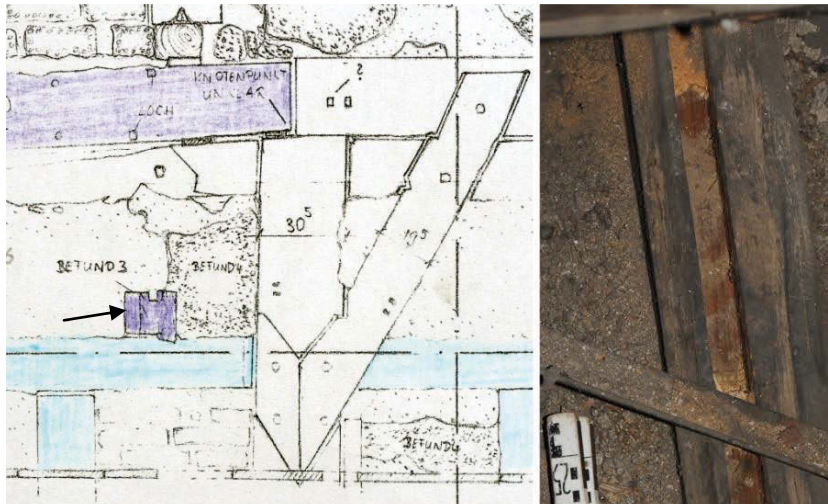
Detail Aufmaß Westgiebel Nordflügel. Nachträglich in das Fachwerk von 1401/02 eingestellte Tragkonstruktion mit zweitverwendeten Deckenbalken (Pfeil und Foto rechts) für die Decke der Kleinen Ratsstube
